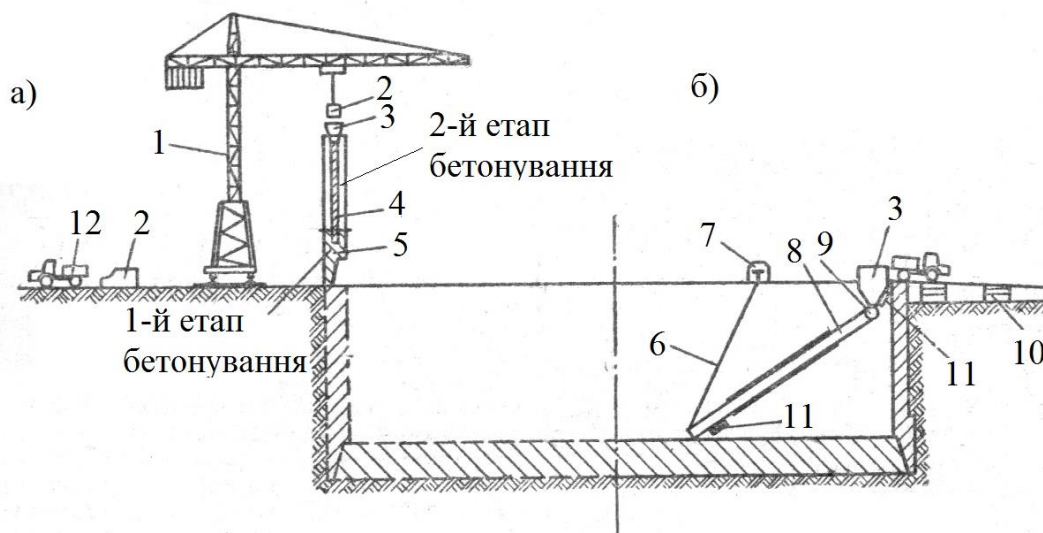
Схеми бетонування стін та днища опускного колодязя:
